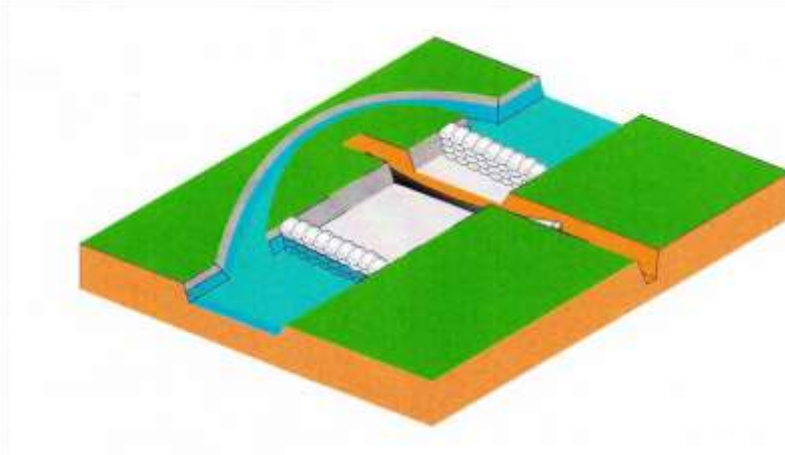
围堰导流开挖管沟法施工断面示意图
